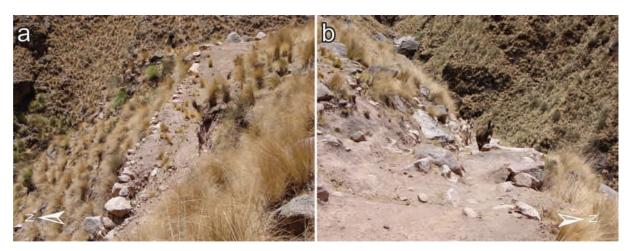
a) Antiguo camino con talud y excavación ubicado por debajo de la senda actual (27° 32' 30.17" S; 67° 13' 44.67" O; 2878 msnm); b) Imagen de un derrumbe de rocas sobre la traza vial. Fotografías del autor.
